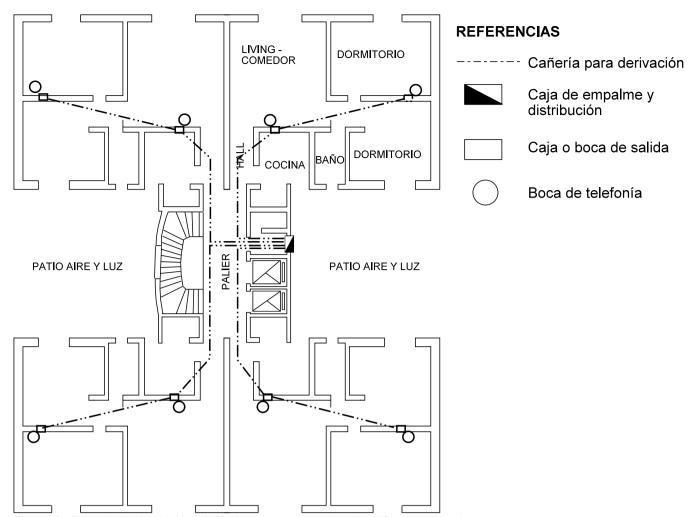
Ejemplo de instalación telefónica en una planta tipo de edificio de viviendas.
